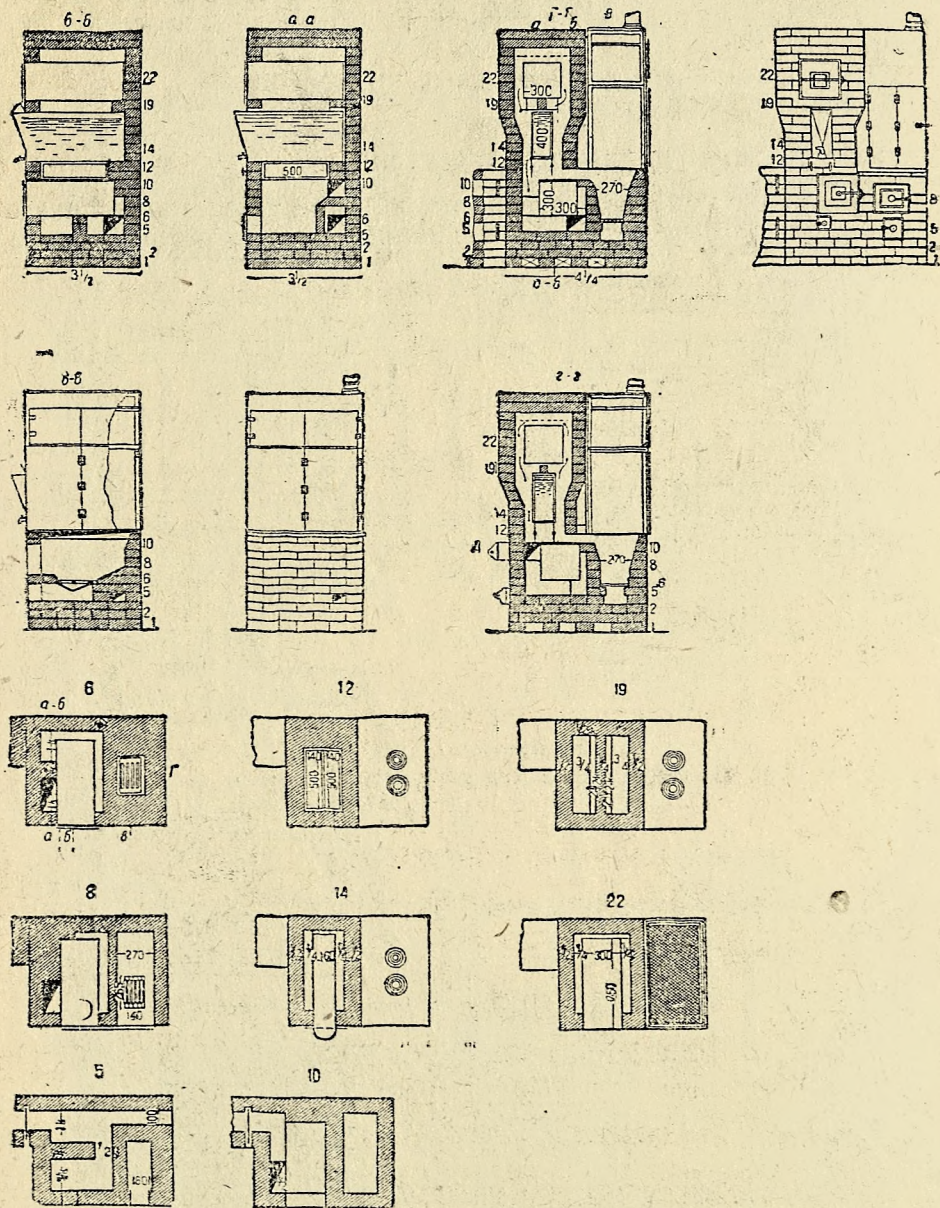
Кухонный квартирный очаг на две конфорки и с термосным шкафом конструкции инж. И. С. Подгородника.
